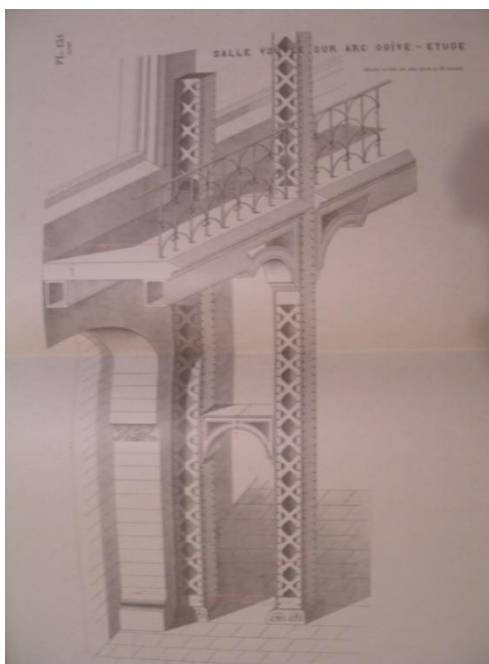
Pilares de acero laminado. Fuente: (Vierendeel, 1902).
